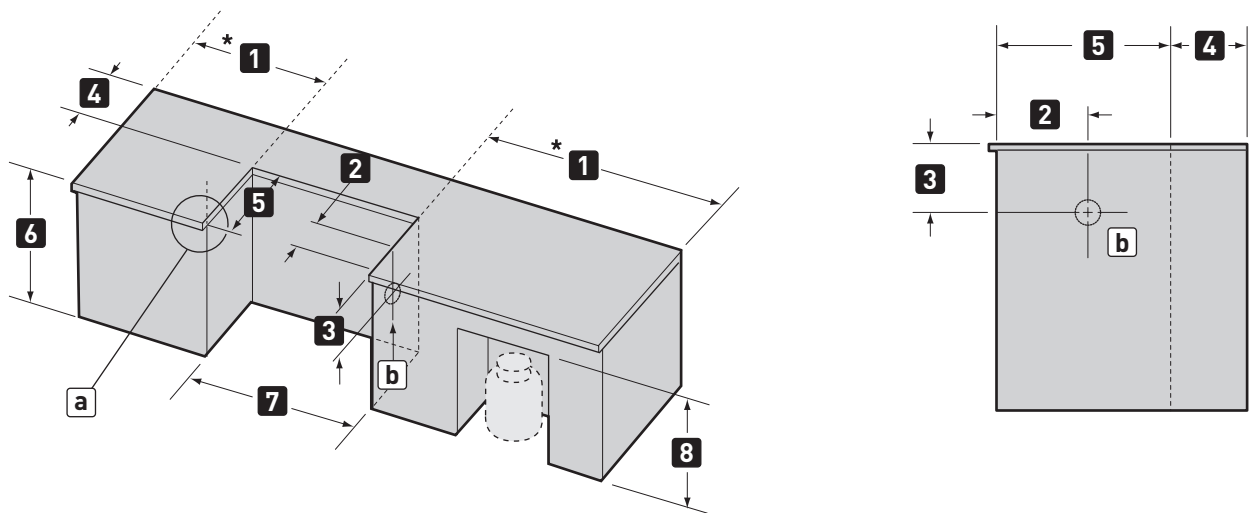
DETAILIERTE ABMESSUNGEN EINES INTEGRIERTEN AUSSCHNITTS – INSTALLATION NEBEN EINEM AUFBAU
